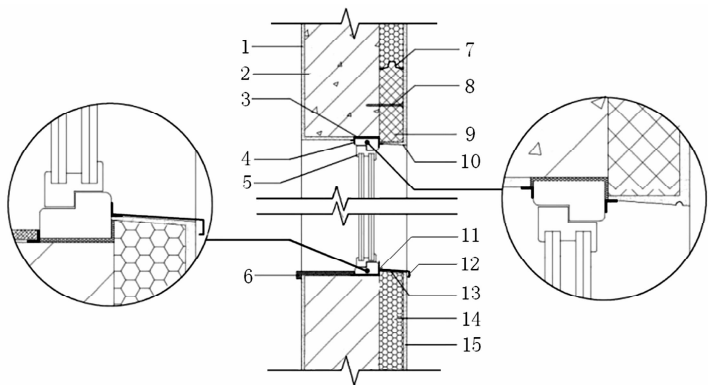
薄抹灰粘贴系统外墙门窗口保温防火构造
